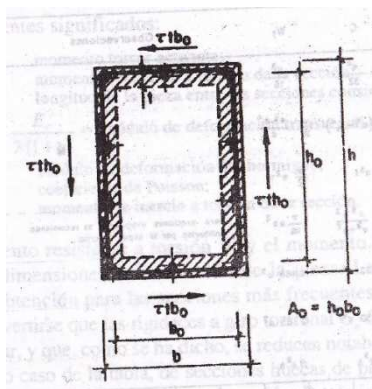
Sección hueca de pared delgada en sección rectangular.
